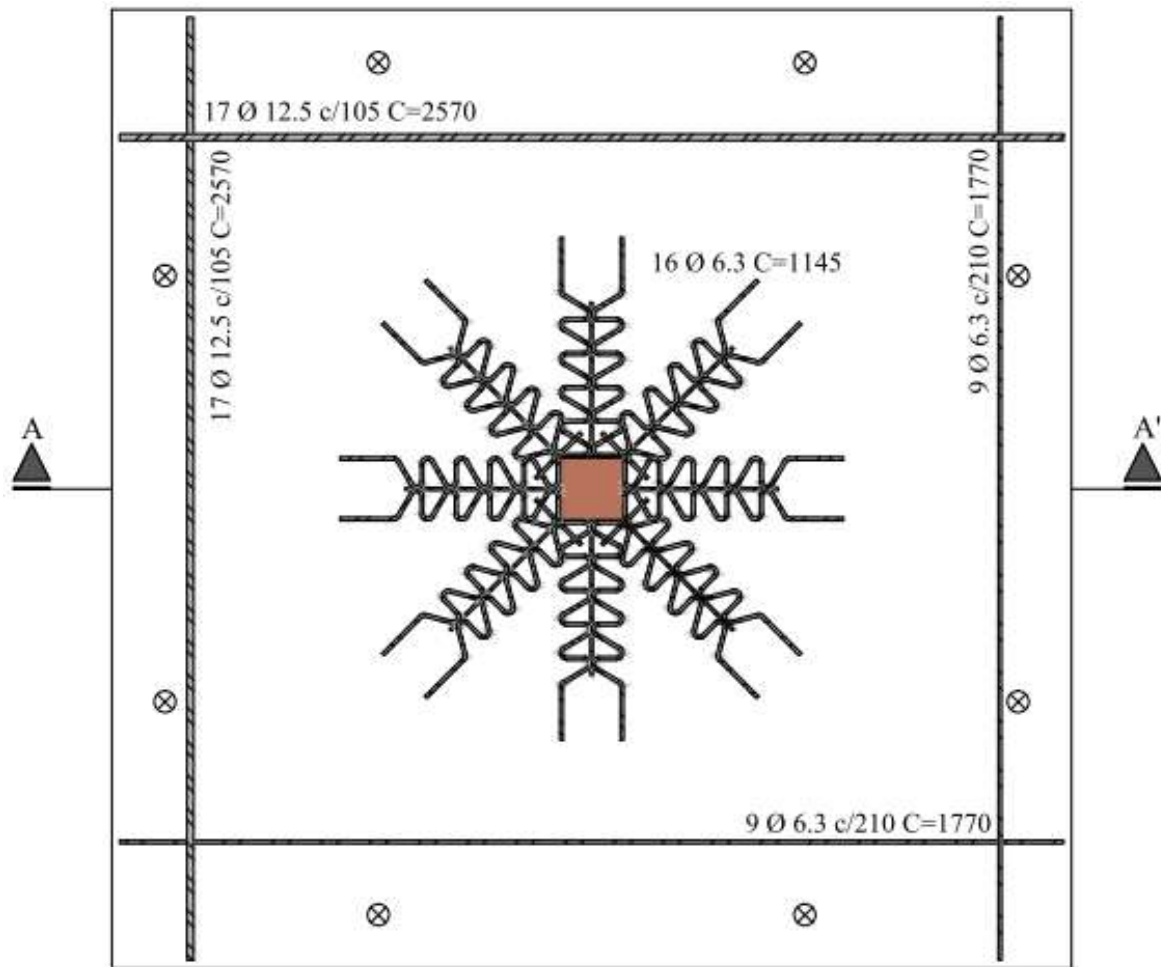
Arranjo das armaduras transversais na laje L3
